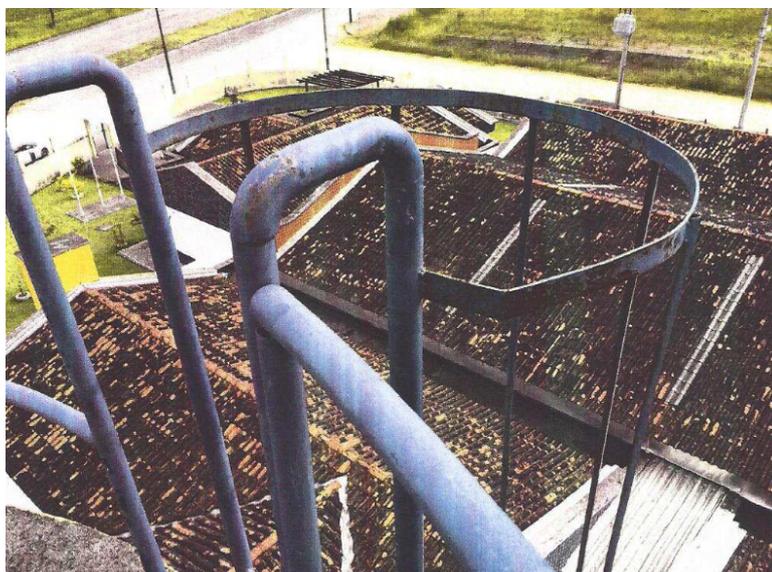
Detalhe da deterioração por corrosão da estrutura da metálica do
